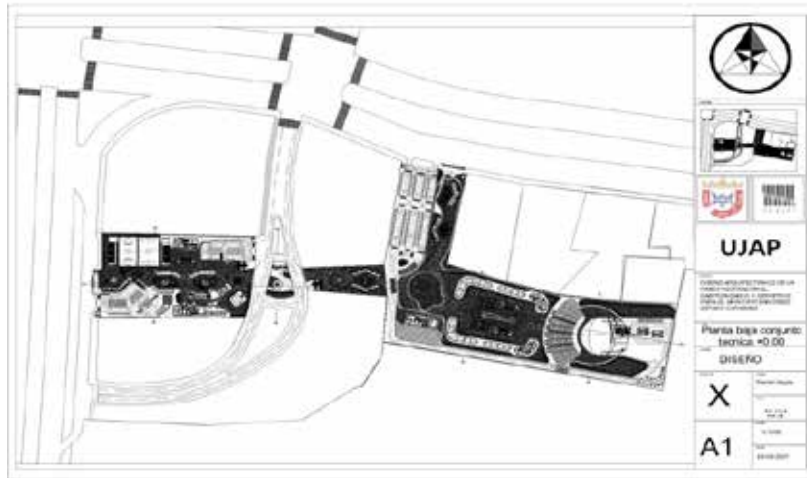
Planta baja nivel ± 0.15 (arquitectura). El autor (2021)
